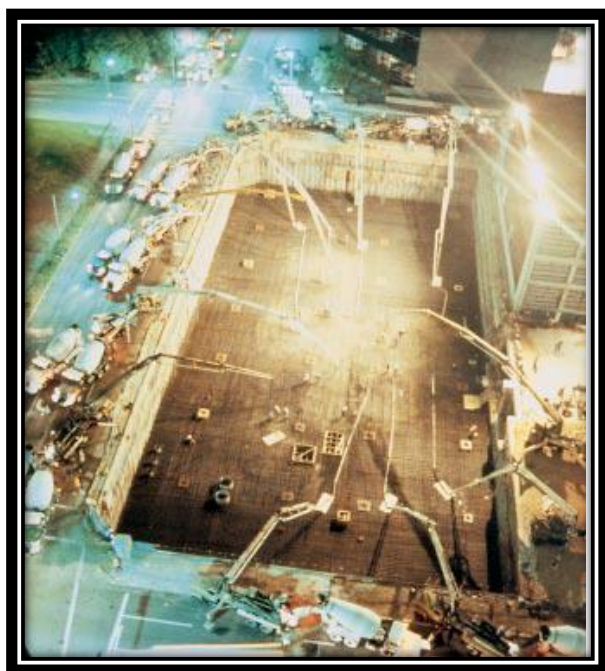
Fig. 2.32 El colado de una cimentación grande como la que se muestra requiere precauciones de concreto masivo.
